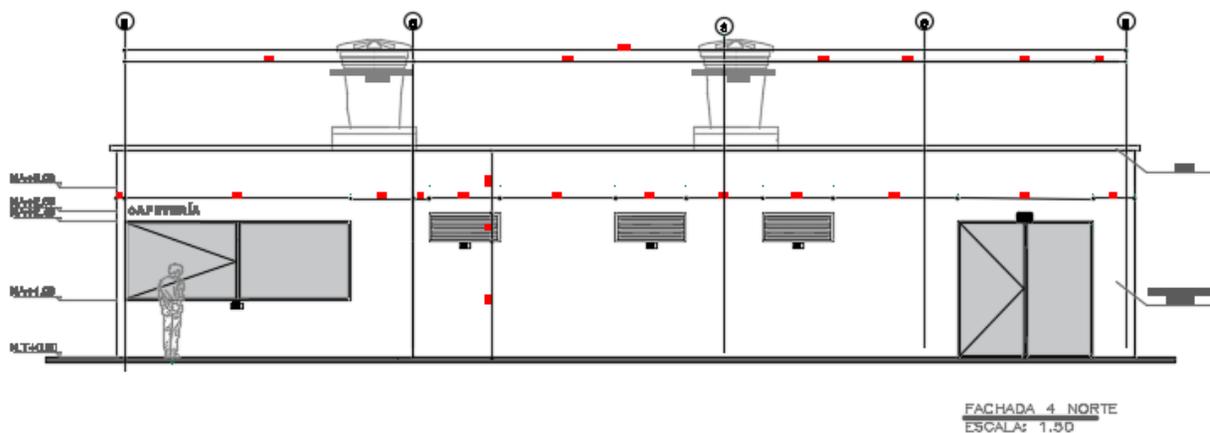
Fachada Posterior Zona de Cafetería y Baños
